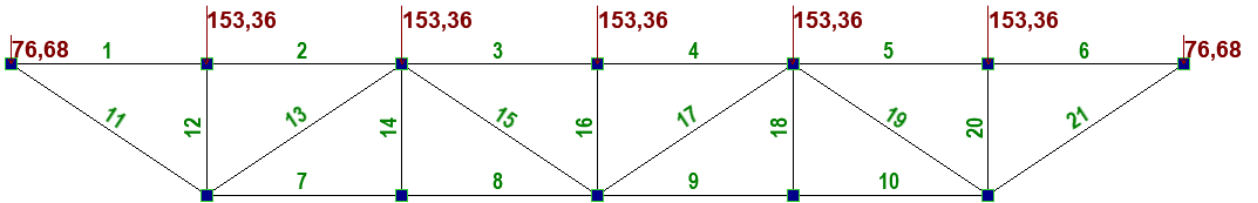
Суммарная узловая нагрузка от двух смежных ферм, кН
